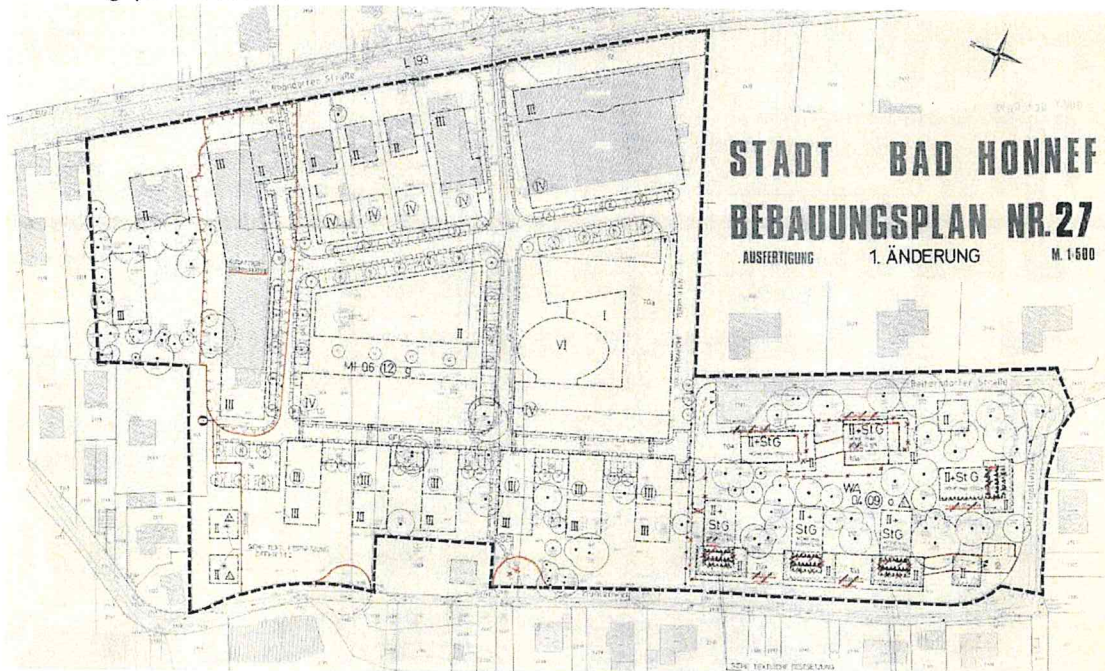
Bebauungsplan Nr. 27 „Firma Penaten“
